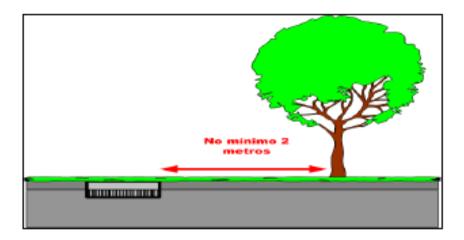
Distância das árvores de bueiros e caixas de inspeção Fonte: Plano de Arborização Urbana de Cascavel
